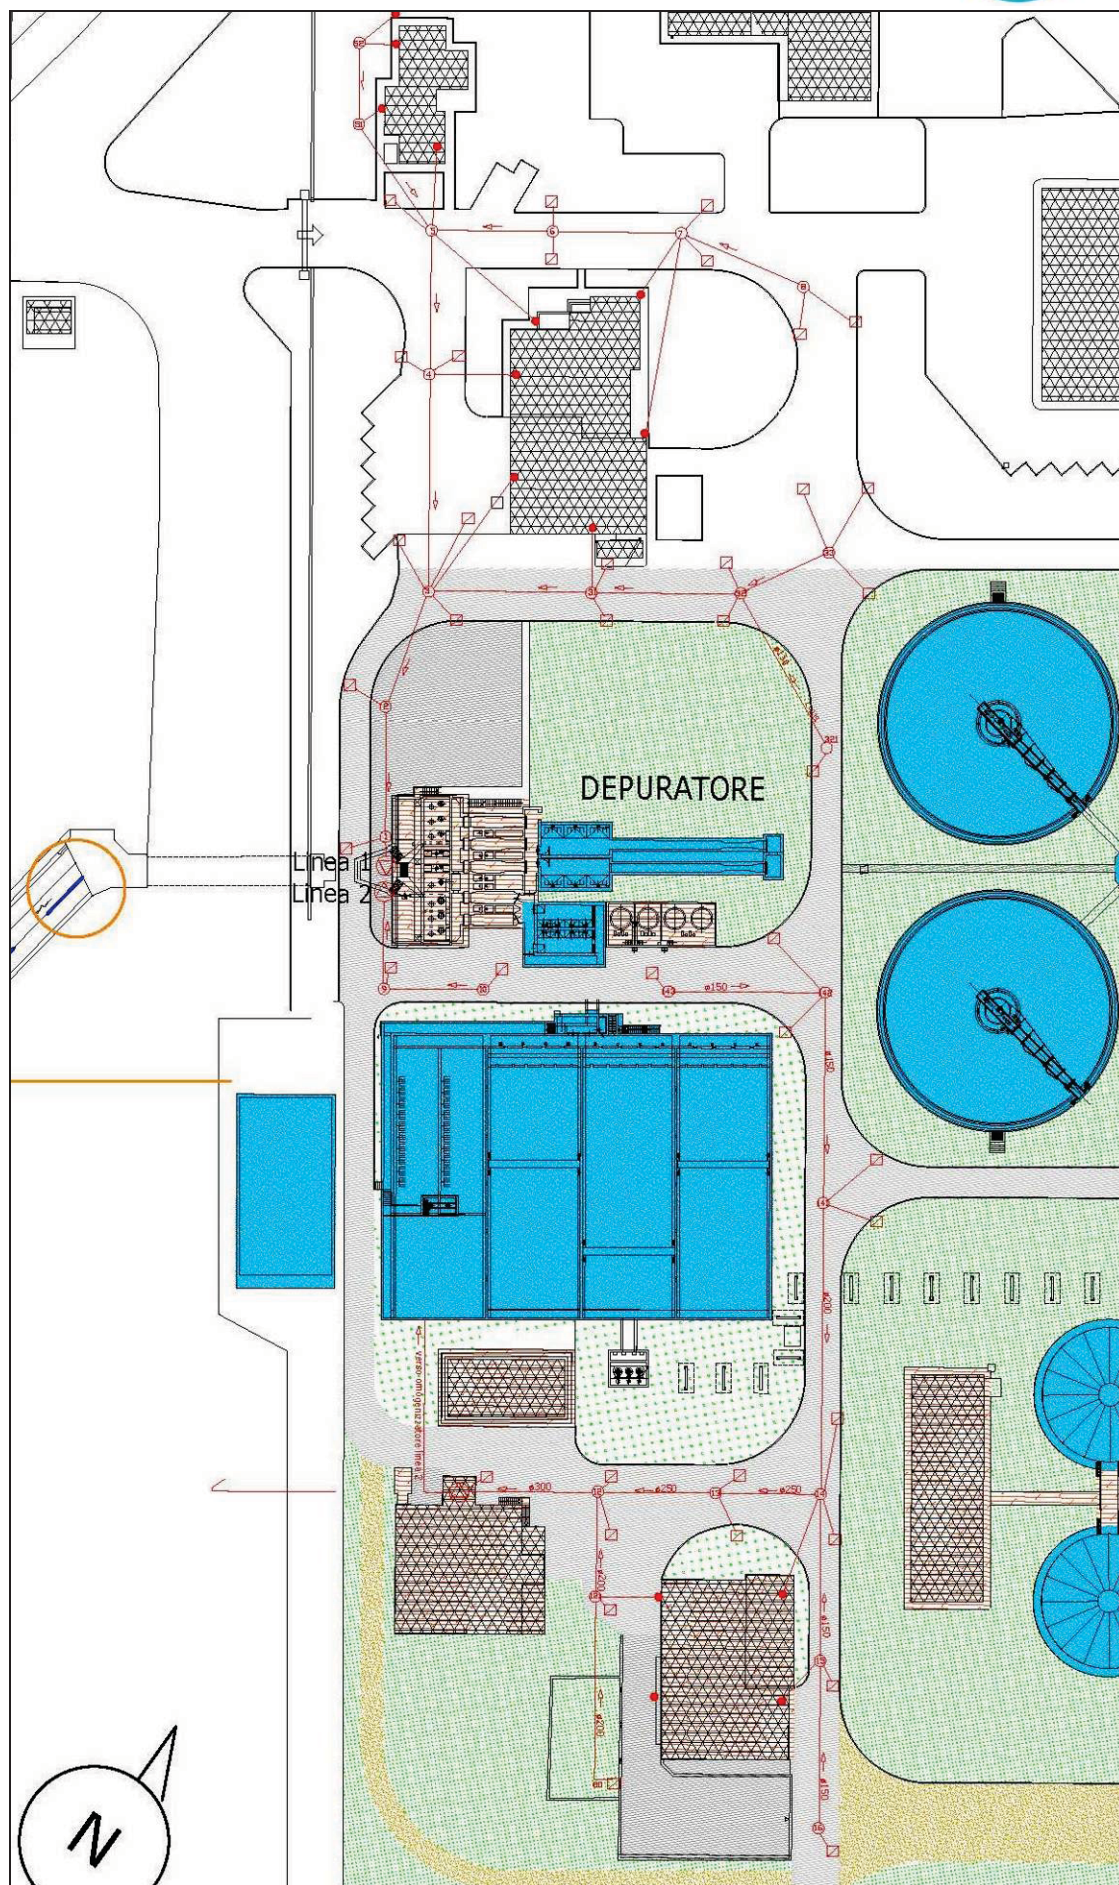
Planimetria della rete fognaria esistente, stralcio della "Tavola 1- Planimetria stato di fatto"
